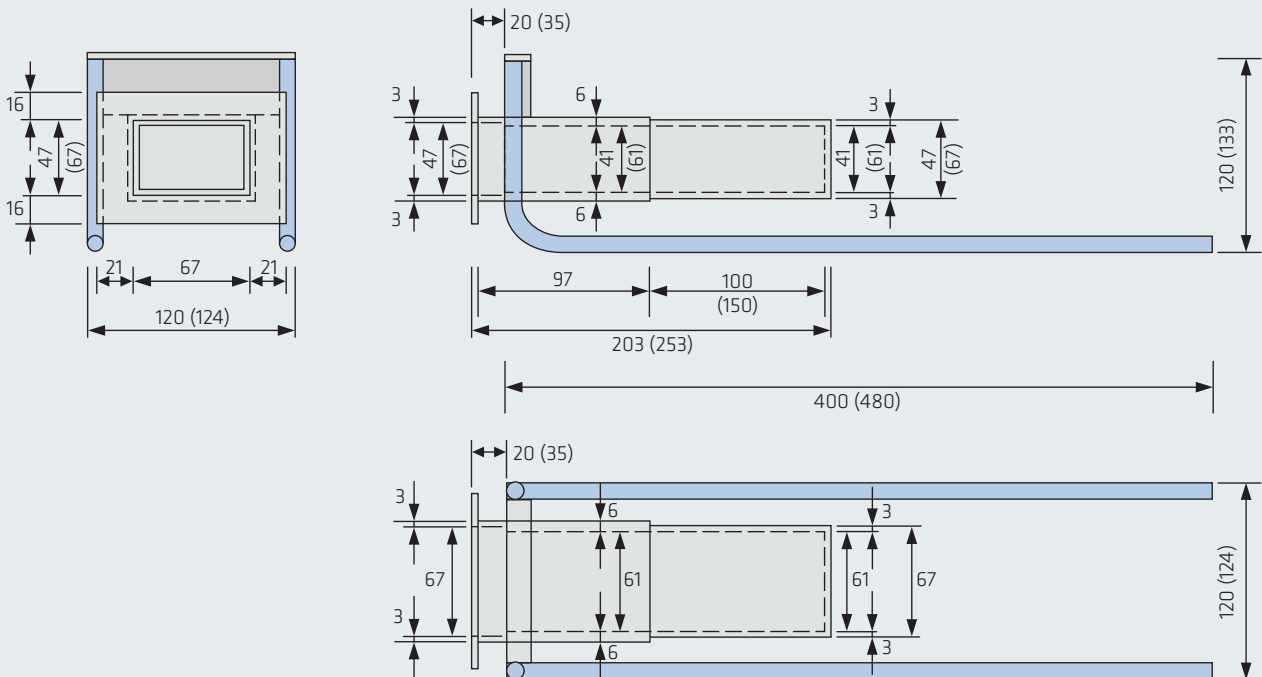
Abmessungen Laufhülse für Typ P2 HQW 60/40 und HQW 60/60 (Klammerwerte)
